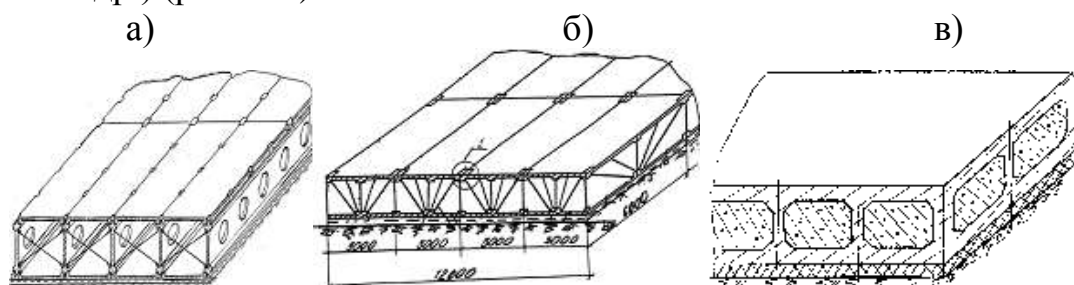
Пространственные фундаментные платформы (ПФП) для строительства на слабых и вечномёрзлых грунтах: а) сборная железобетонная платформа (патент РФ на полезную модель № 38789); б) сборная сталежелезобетонная фундаментная платформа (патент РФ на изобретение № 2206665); в) монолитная фундаментная платформа с утеплителем (патент РФ на полезную модель № 45410)
